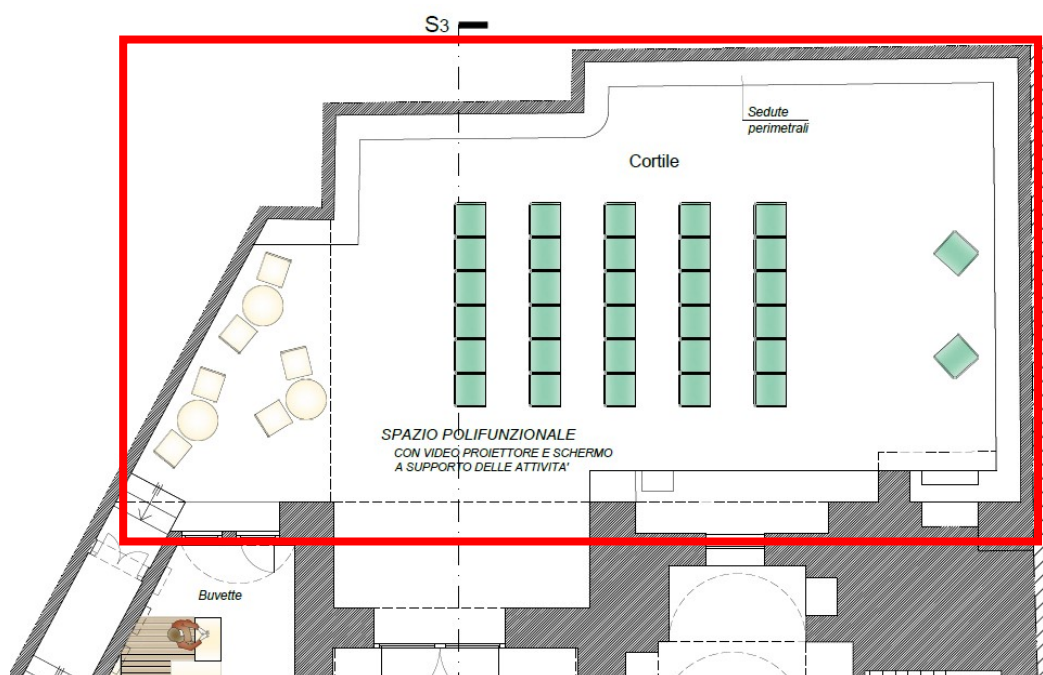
Stralcio della planimetria del piano terra con individuazione della corte interna (in rosso)
